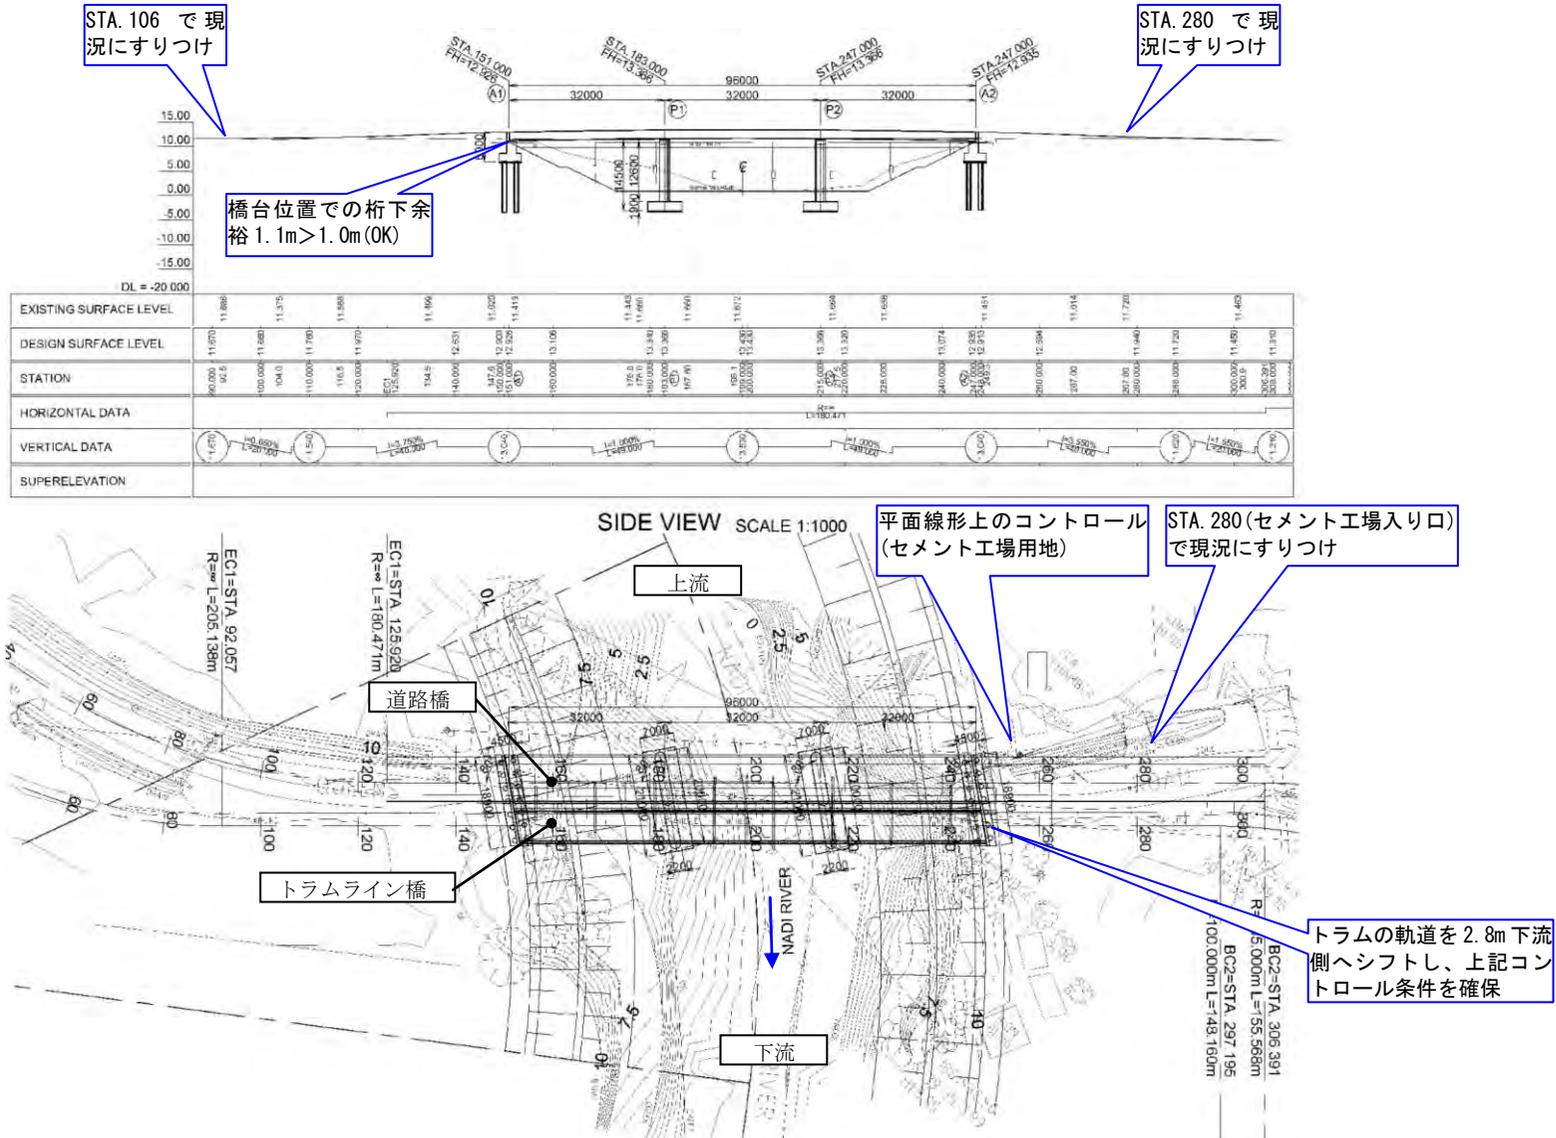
計画平面図および縦断図(Old Queens Road Bridge)
